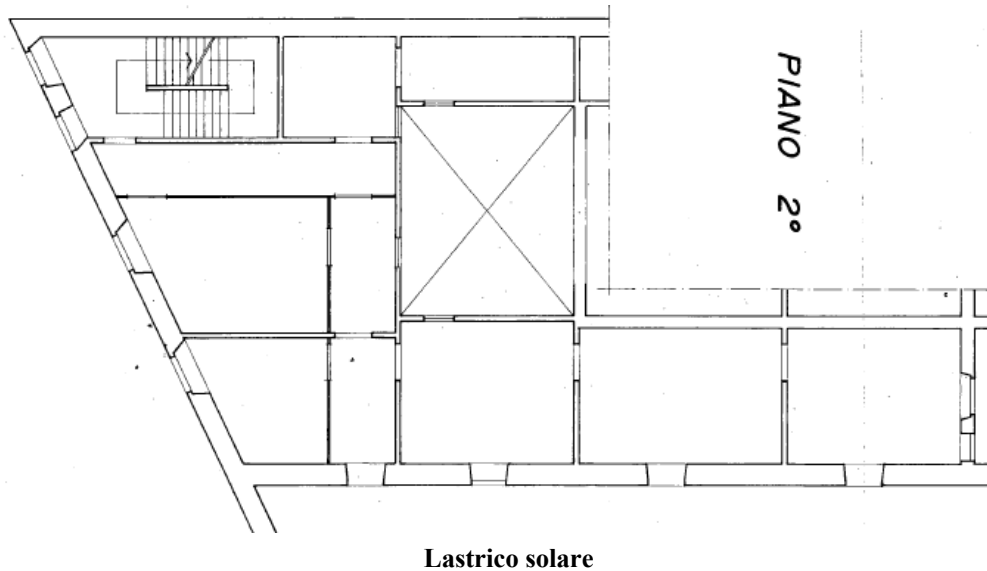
Planimetria dell'appartamento posto al piano secondo
